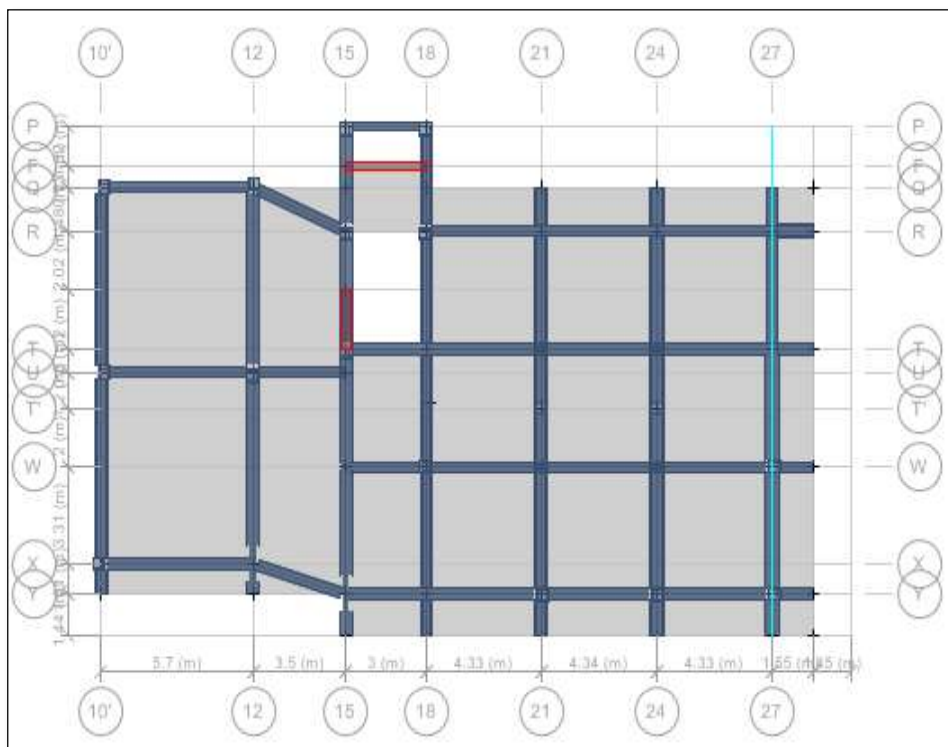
Esquema de ubicación de muros en concreto, Estructura 5.2 Hotel
